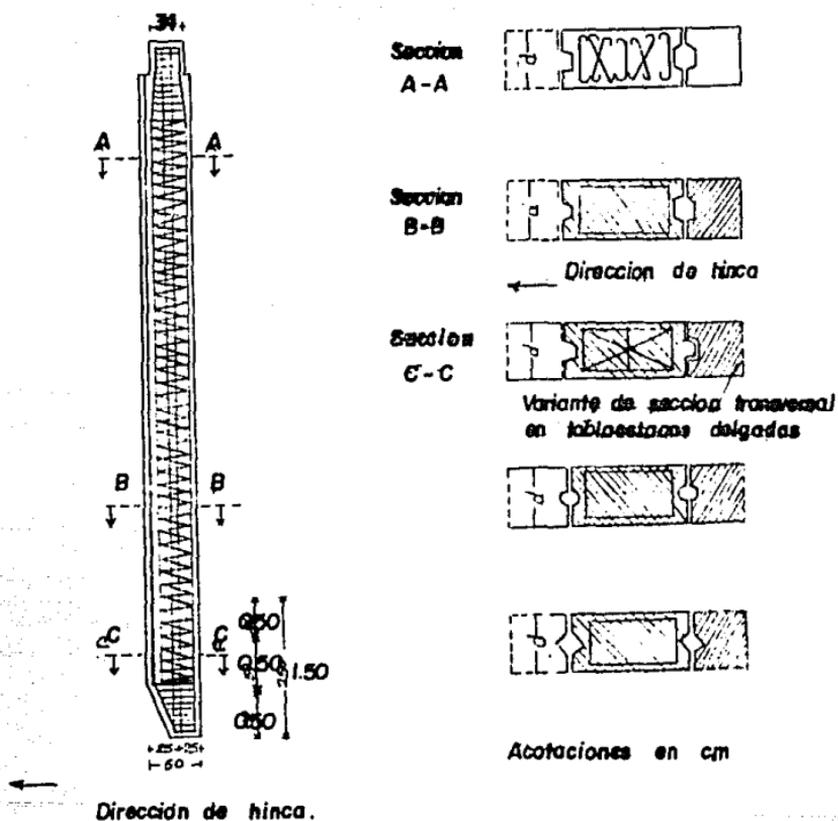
Tabloestacado de hormigon armado
